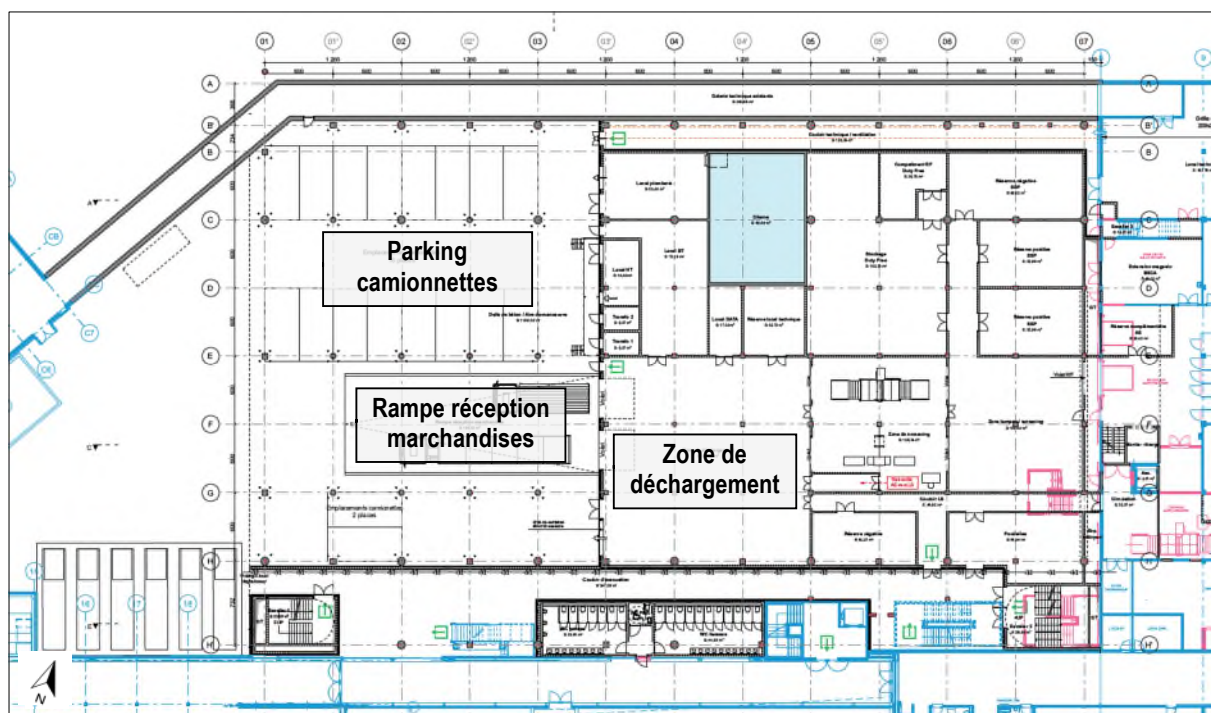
Extension du PIF Nord – Plan Rez-de-chaussée – Niveau +174,00 m (BAG-AERTEC, 2024)
